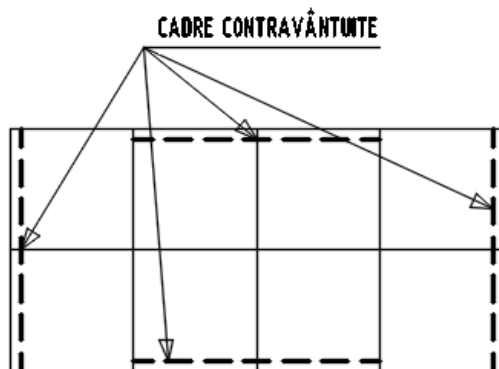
1 Dispunerea în plan a cadrelor contravântuite
